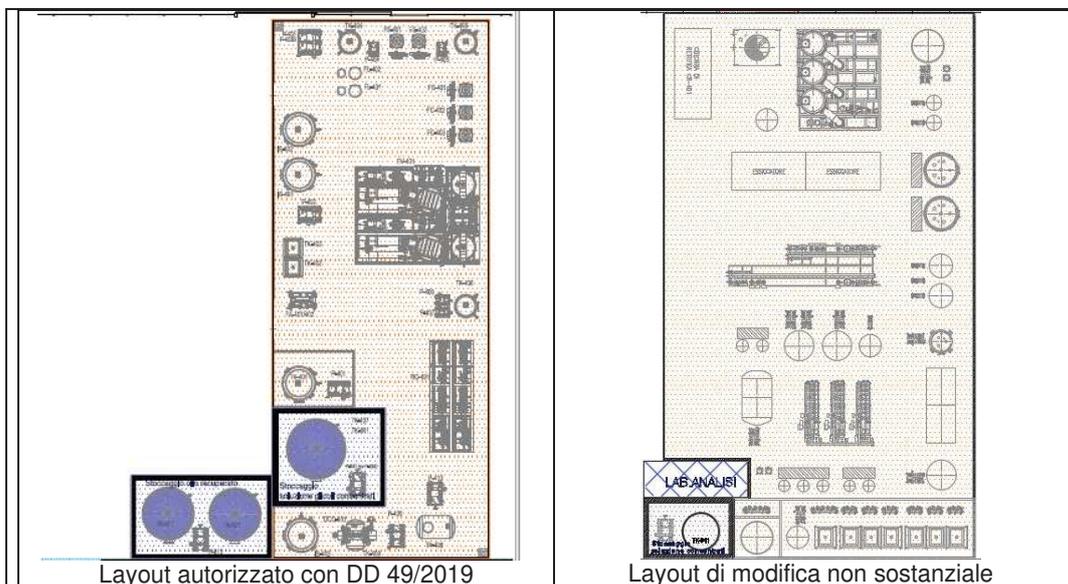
confronto tra il layout autorizzato ed il nuovo layout in progetto
